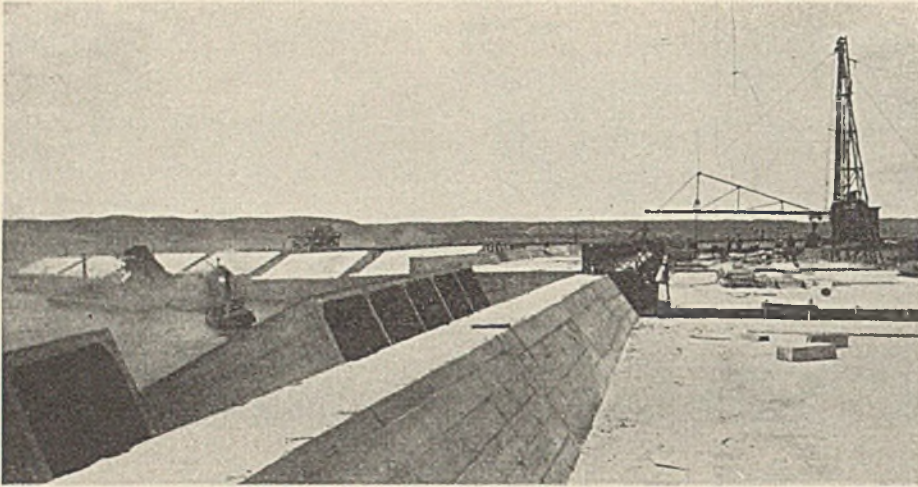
Herstellung der Eisenbeton-Senkkasten.
